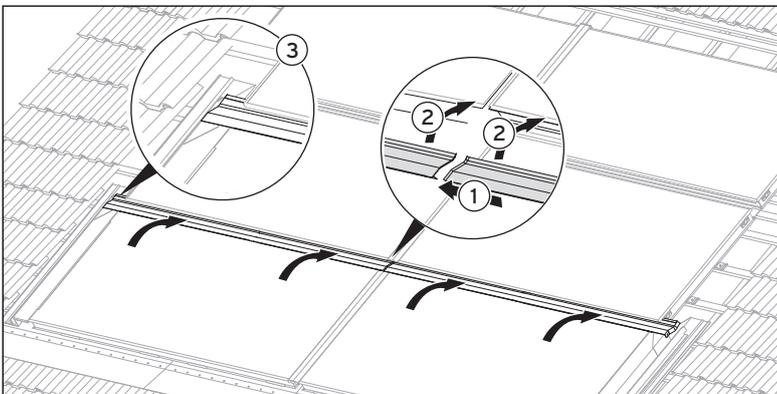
Zwischenbleche befestigen (hier horizontal)
